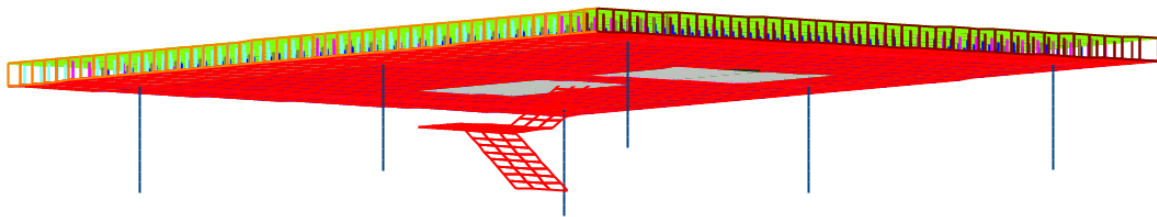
Vista inferior da Laje do 1 Pavimento da Estrutura Original
